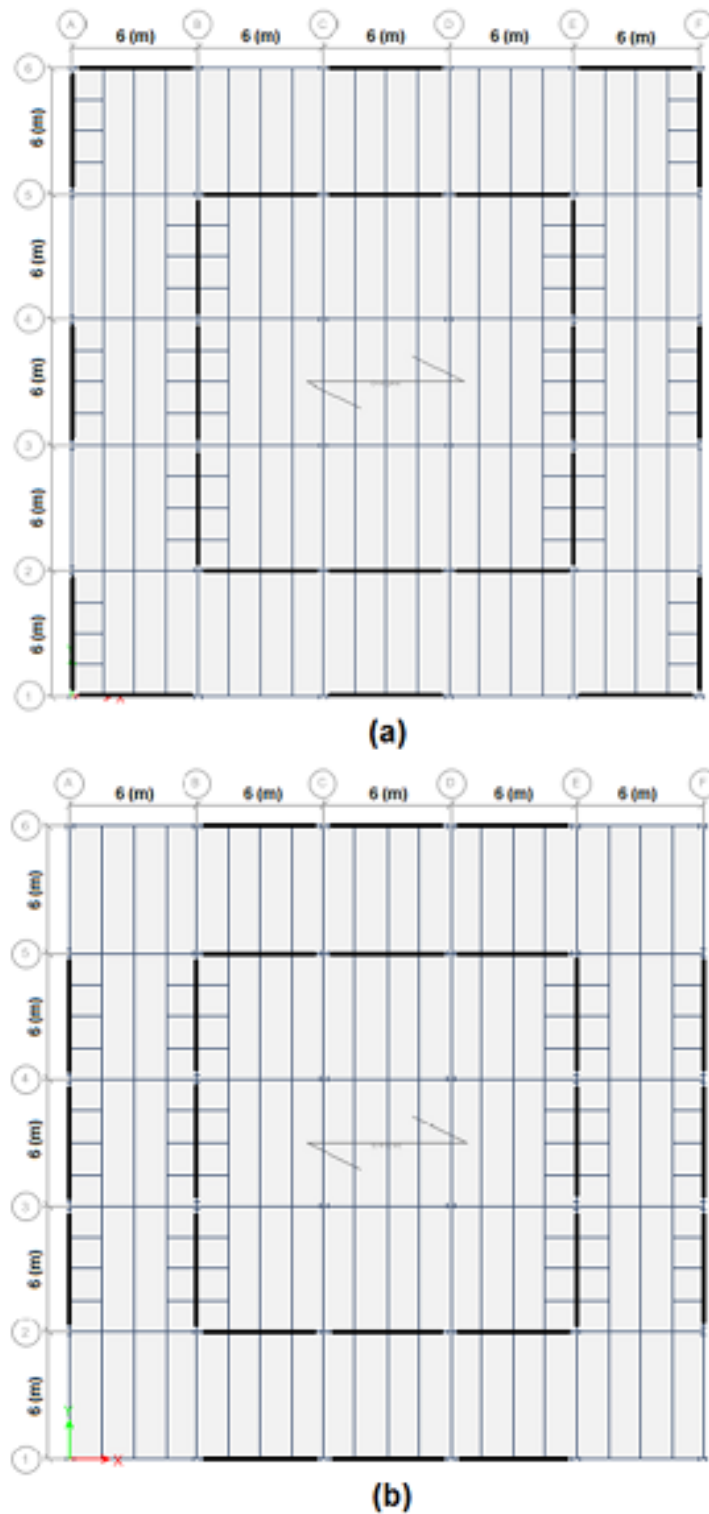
Vista en planta de la edificación de 5 niveles (a) Variante 1 y (b) Variante 2.
